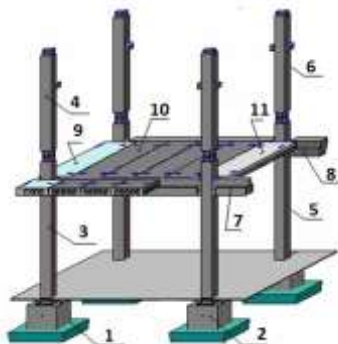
Сборные несущие конструкции многоэтажного каркасного здания: 1 – фундаментная плита, 2 – башмак под колонну. 3 – колонна нижняя одноконсольная, 4 – колонна средняя одноконсольная, 5 – колонна нижняя двухконсольная, 6 – колонна средняя двухконсольная, 7 – ригель двухполочный для опирания многопустотных плит, 8 – ригель однополочный для опирания многопустотных плит, 9 – многопустотная крайняя плита перекрытия, 10 - многопустотная рядовая плита перекрытия, 11 – многопустотная междуколонная плита перекрытия.
